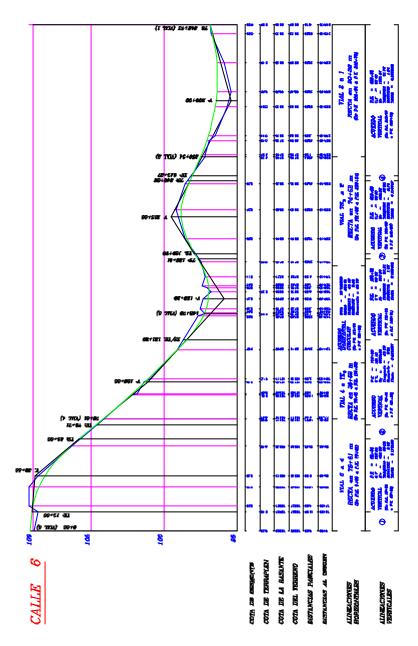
Perfil longitudinal proyectado para una de las calles de la urbanización
